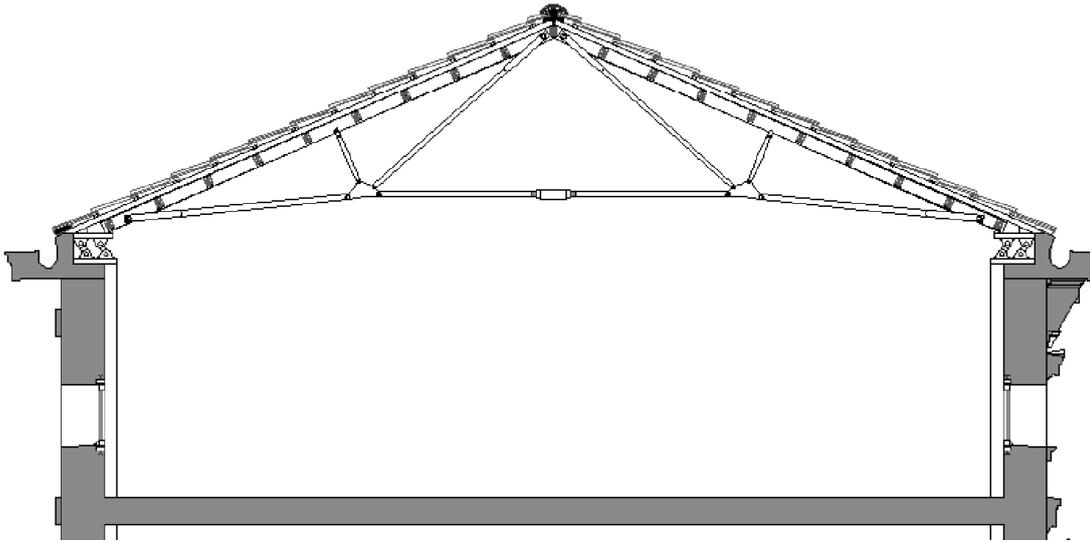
Sección modificada gracias a la toma de medidas en la planta.
